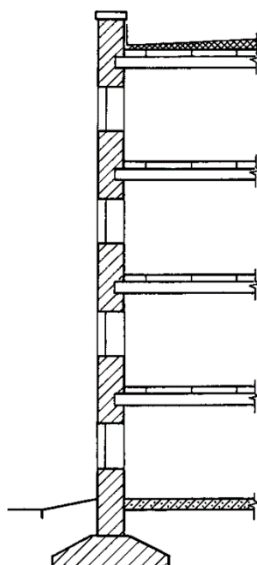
Сопряжение наружной стены с плитами перекрытия и покрытия
